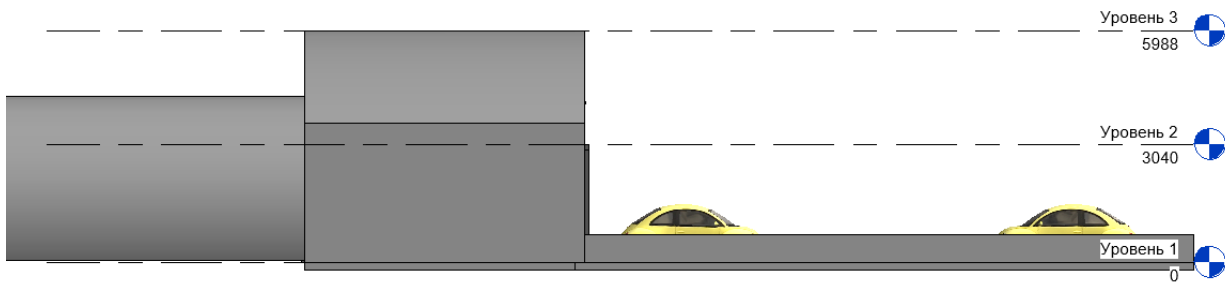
Архитектурно-планировочное решение (фасад - западный)
